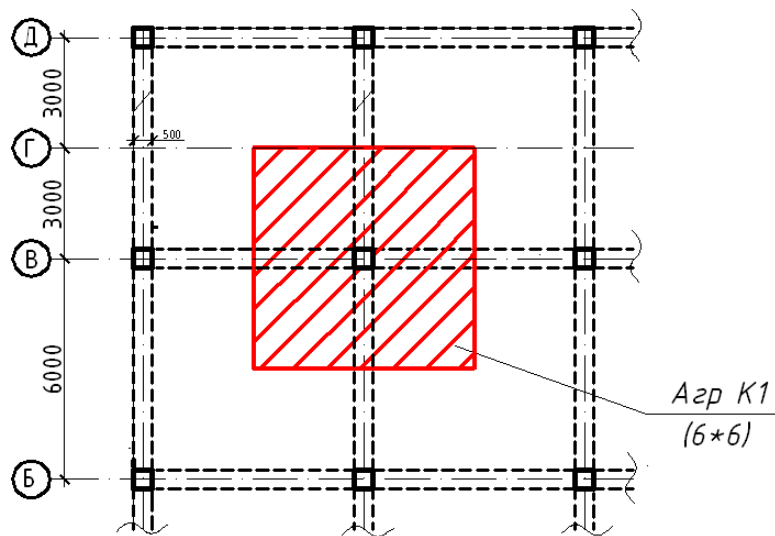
Сбор нагрузок на центрально сжатую колонну
